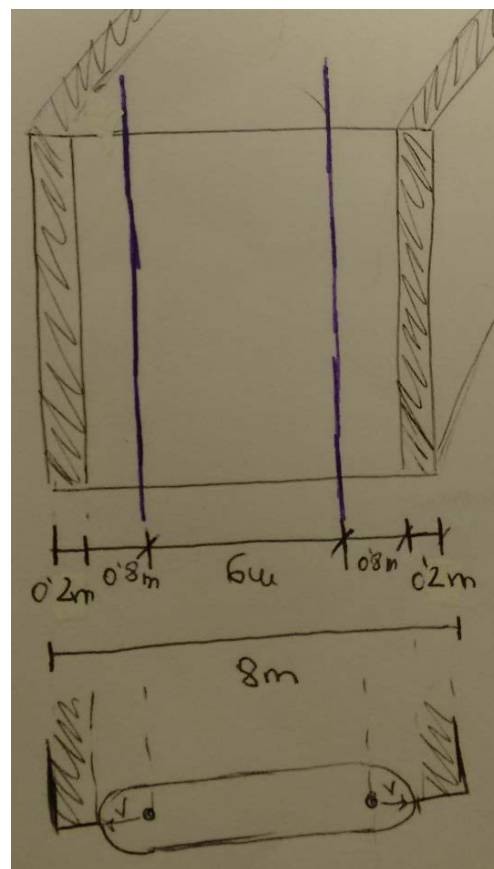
Croquis en detalle de la unión con estribo (Fuente: propia)
